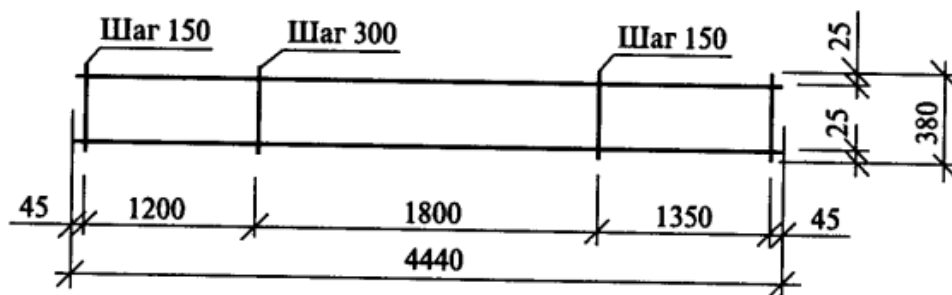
Конструкция каркаса балки – к примеру 7.9
